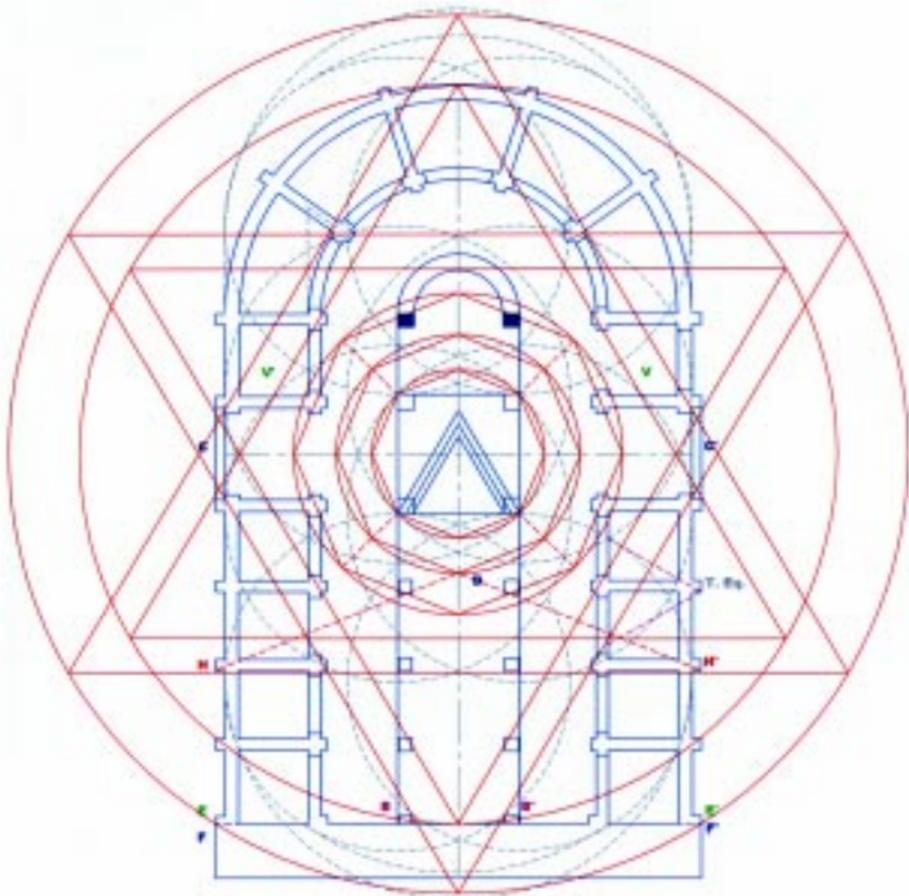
Reconstrucción de la planta de la Primera Iglesia Basical.
